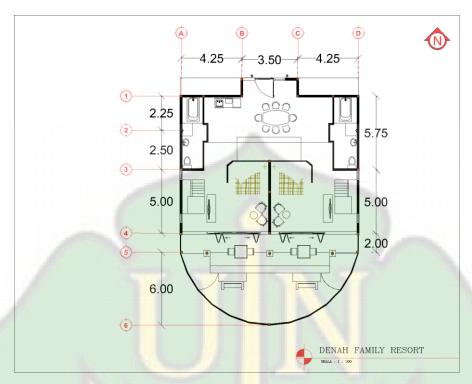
12 Denah Bangunan Utama Lantai 1
